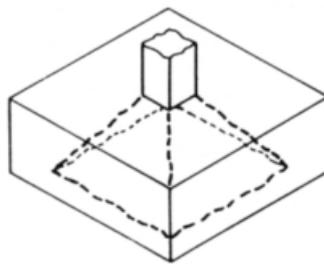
Rotura de zapata. (Fernández, 1926a, 64)
